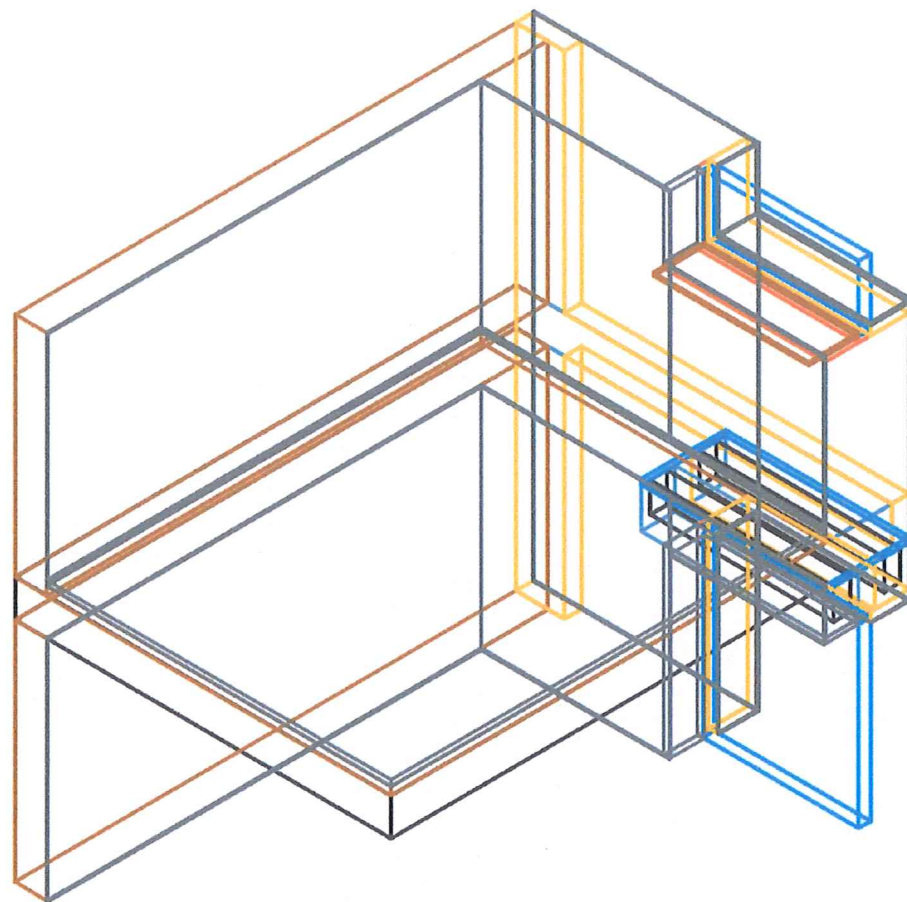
Расчетная схема узла углового сопряжения наружной стены квартиры в уровне перекрытия
